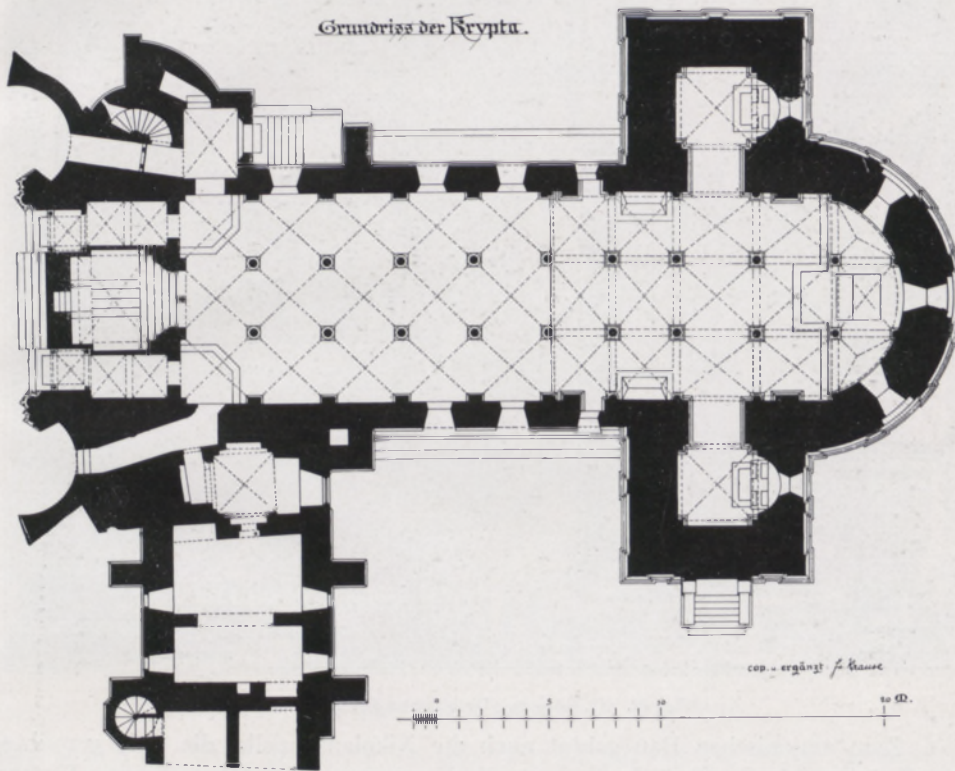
St. Gereon. Grundriss der Krypta.
